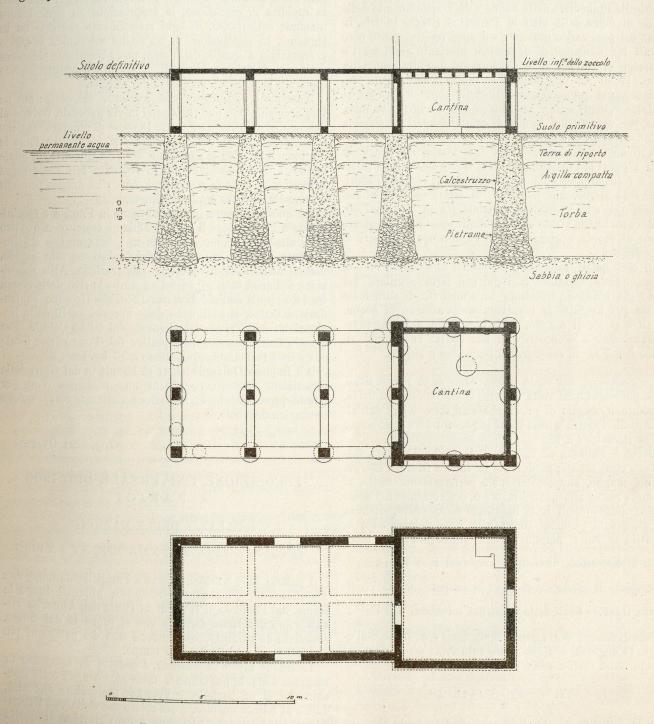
, 79 e 80. — Pianta e sezione di casa fondata col sistema Dulac.
